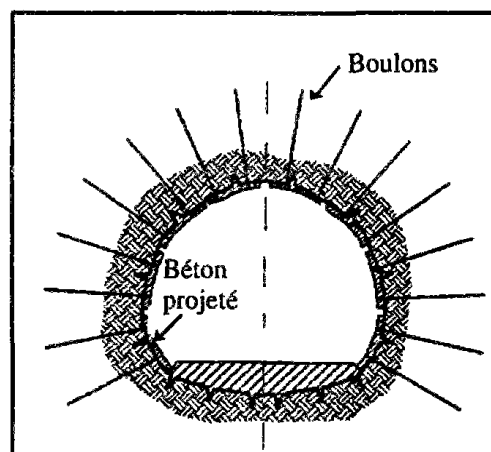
Section de tunnel avec béton projeté et boulons (Benamar, 2010)
